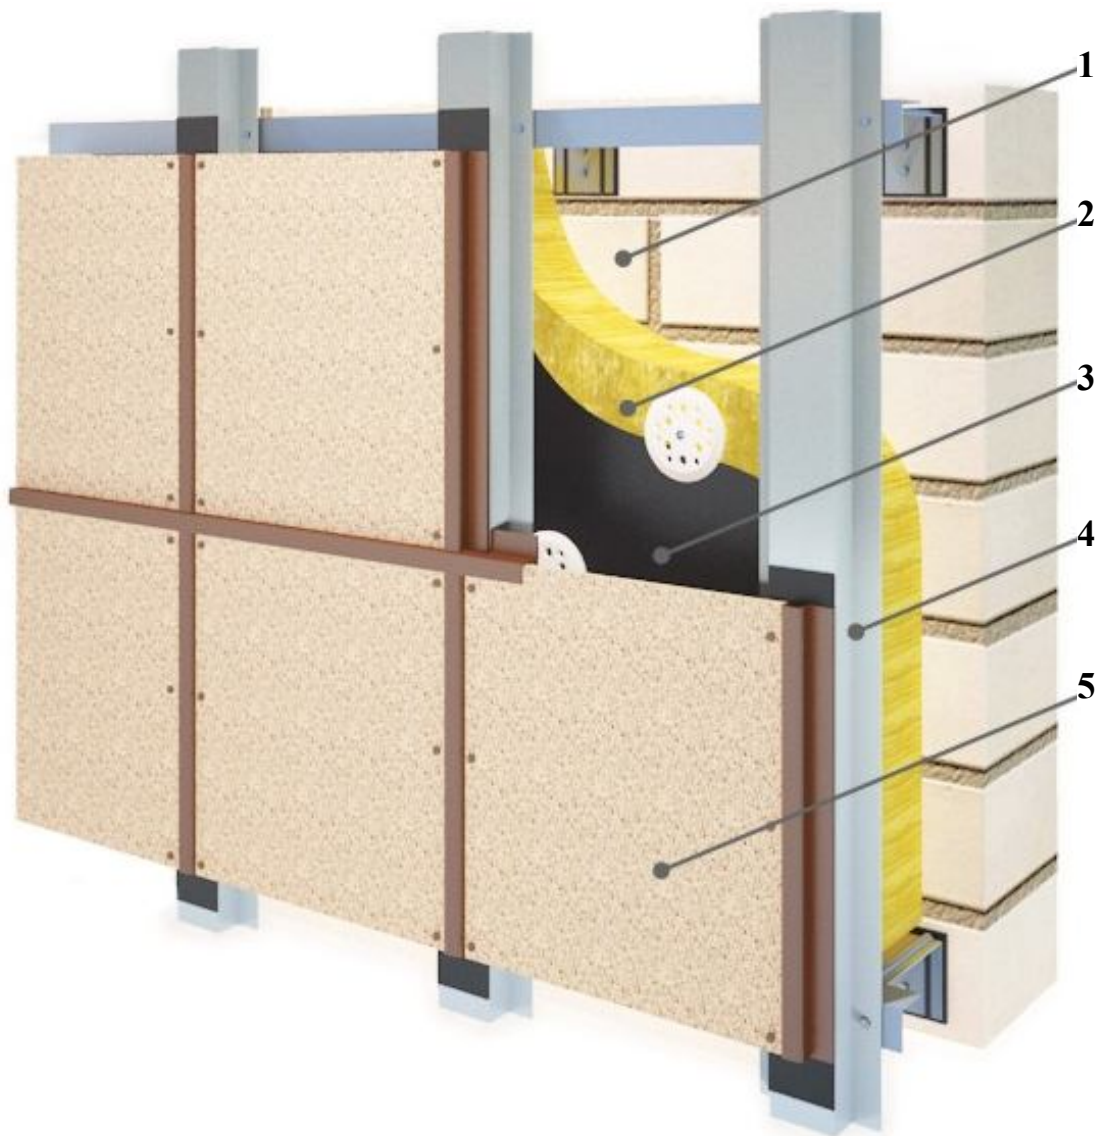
Вентильований фасад з фіброцементних плит:
